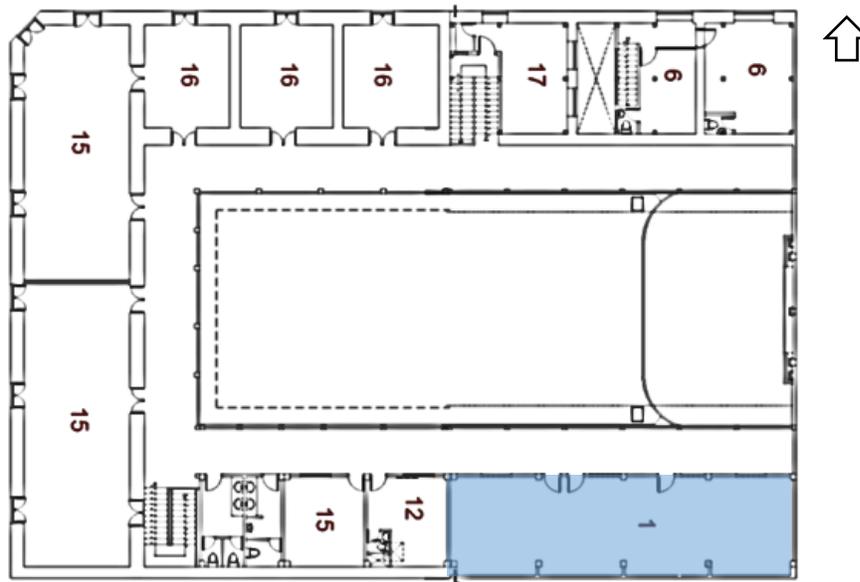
Planta baja Centro Cultural Alfredo Mora Reyes
